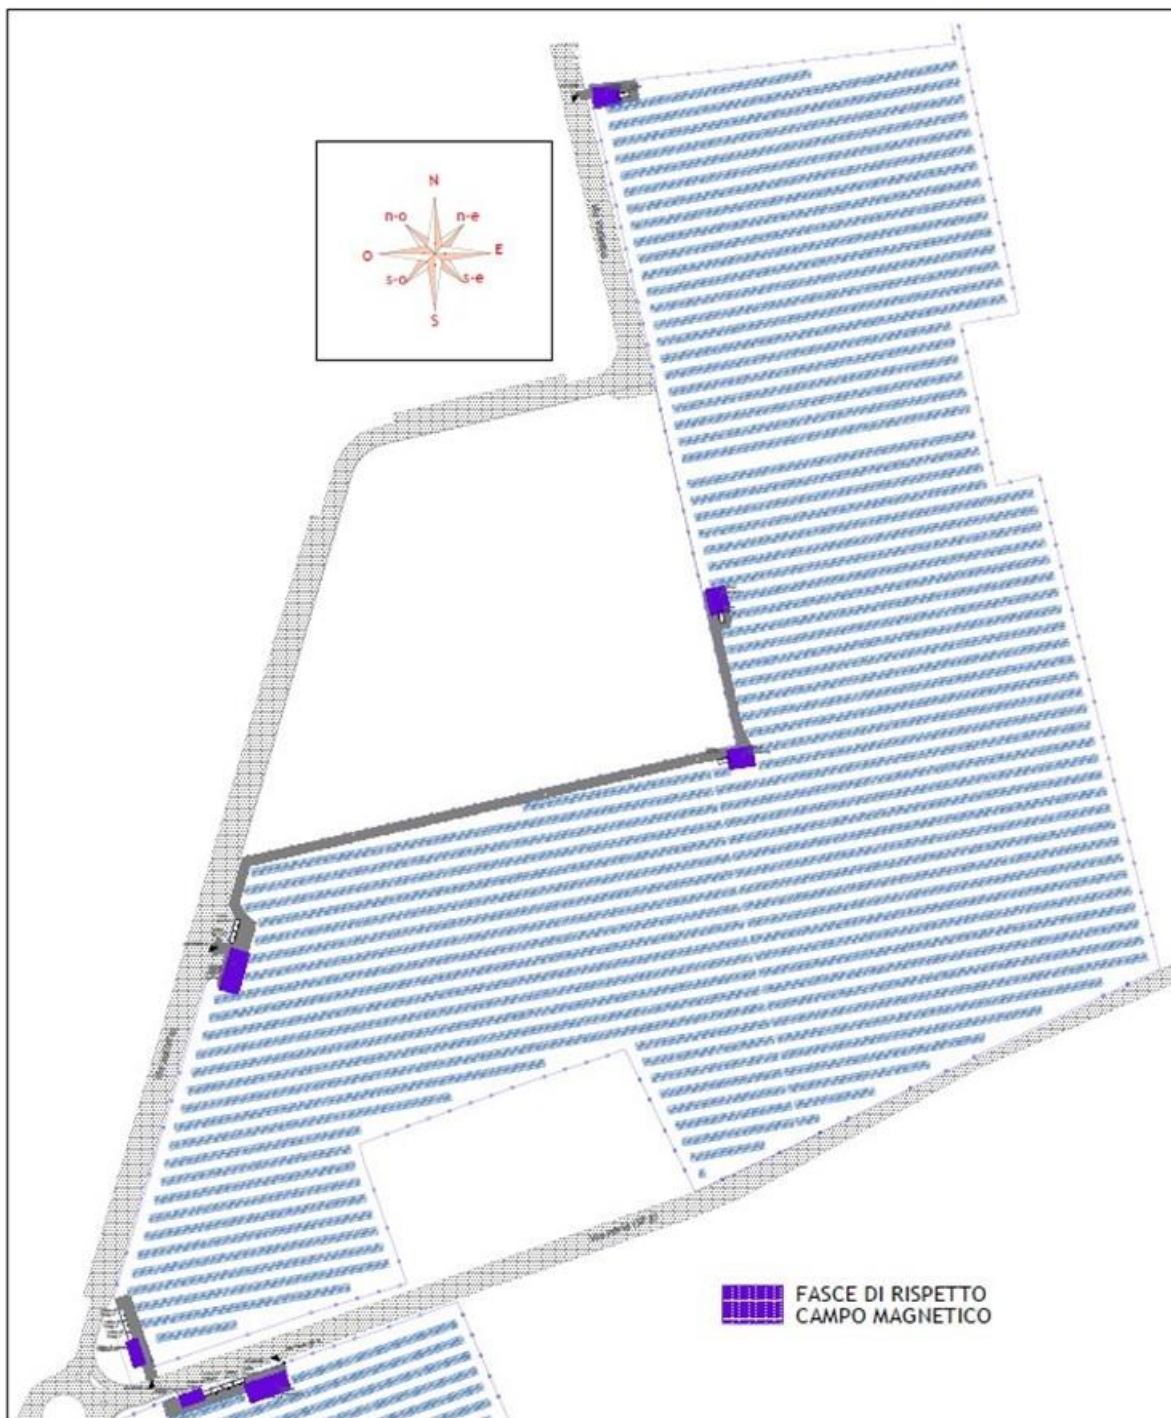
Planimetria con l'individuazione delle fasce di rispetto area Nord
